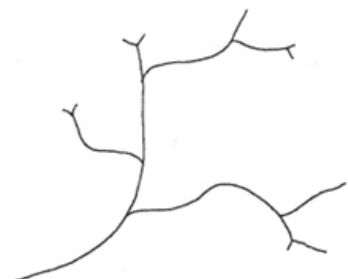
Fissuras ramificadas [Argilés, Josep M. et al (1999c)]
